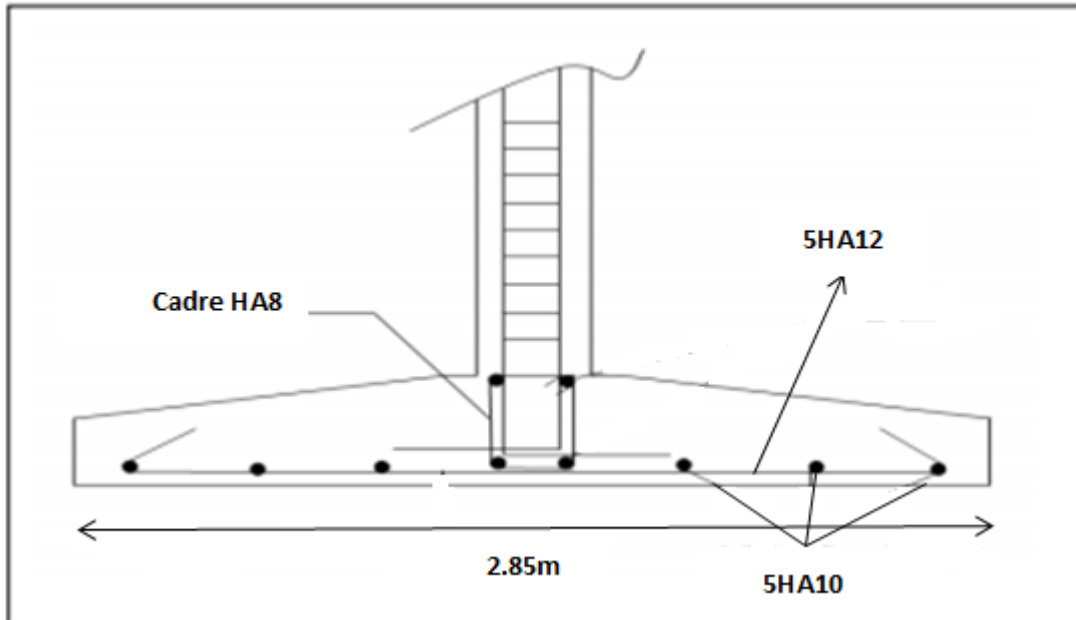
Exemple de ferrailage d'une semelle filante sous voiles.
